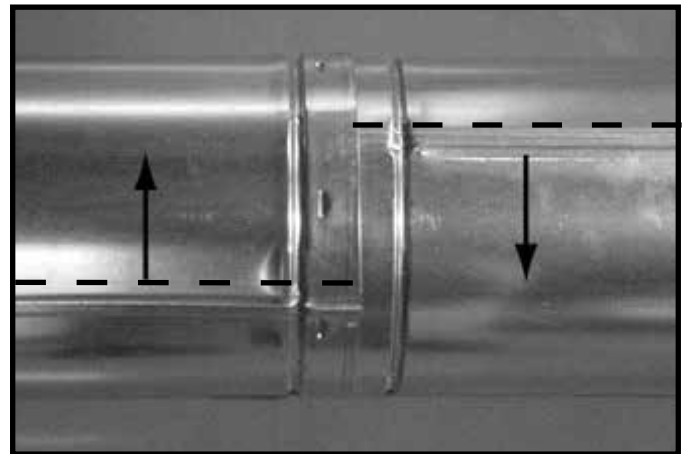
Faire pivoter les cordons de soudure pour démonter
